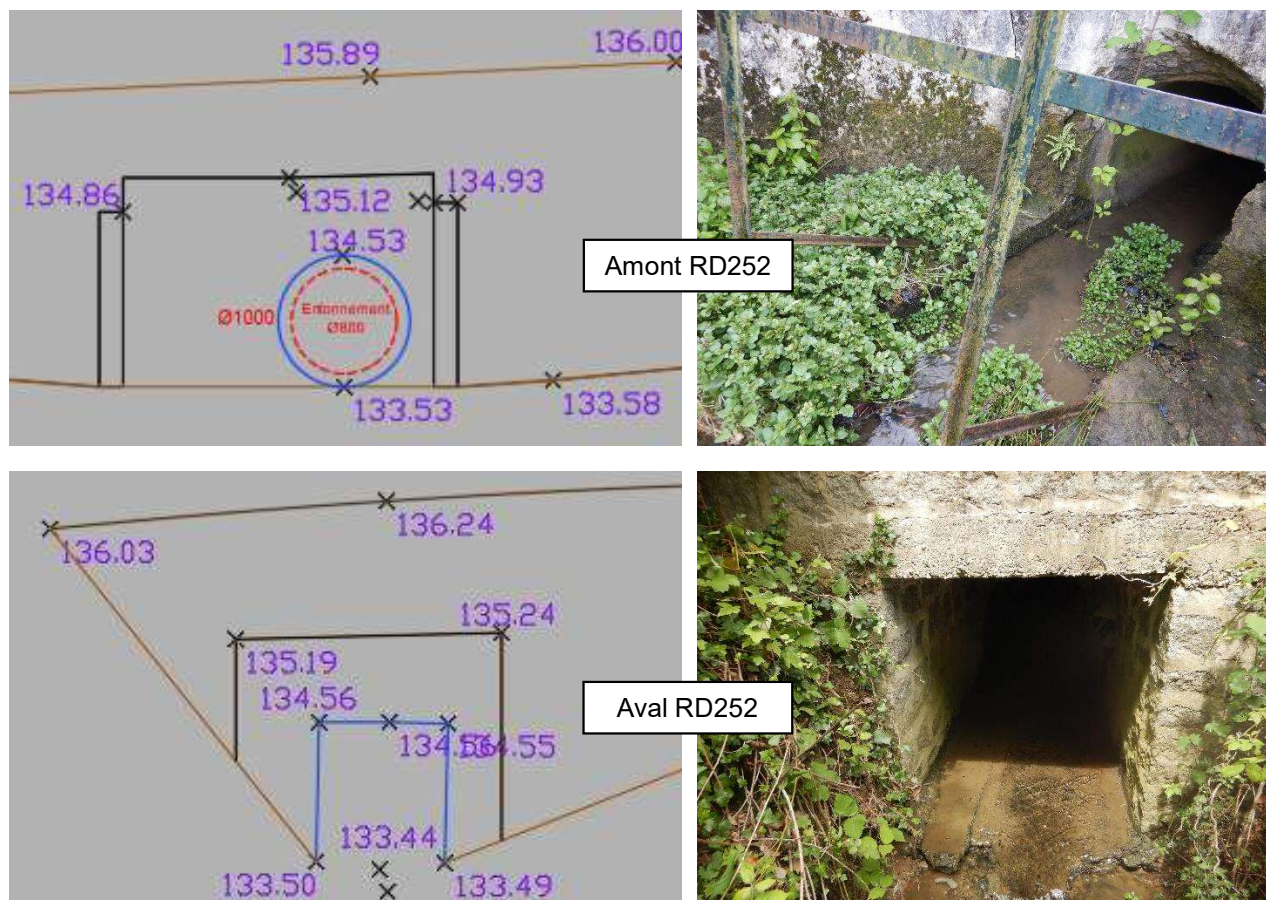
Plans et photographies de l'ouvrage exutoire du plan d'eau
